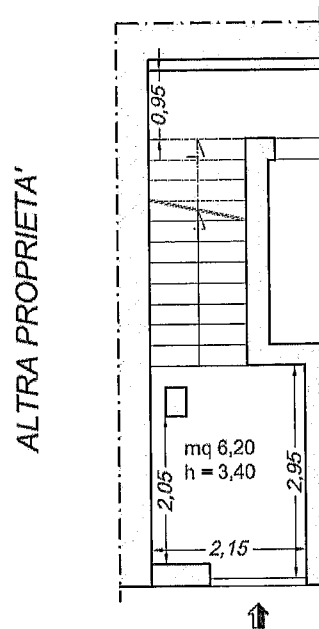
Planimetria Stato di Fatto Piano Terra.
